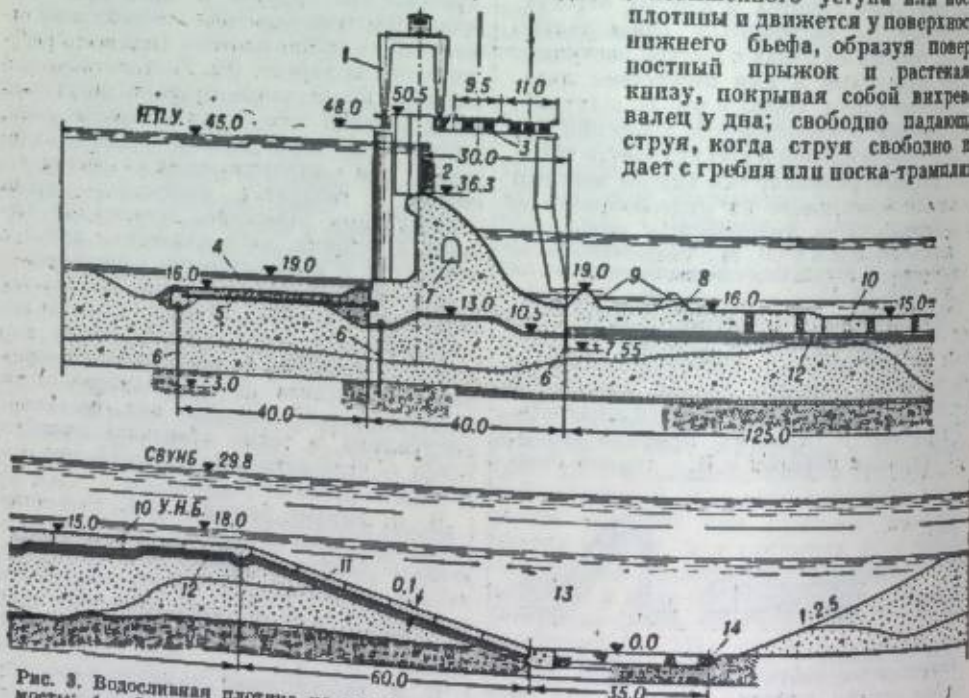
Водосливная плотина на нескальном основании: 1 — подъемный кран; 2 — затвор; 3 — бык; 4 — бетонное покрытие; 5 — понур; 6 — металлические шпунты; 7 — смотровая галерея; 8 — водобой; 9 — гаситель энергии; 10 — рисберма; 11 — плитное крепление; 12 — обратный фильтр; 13 — ковш; 14 — каменная наброска.
